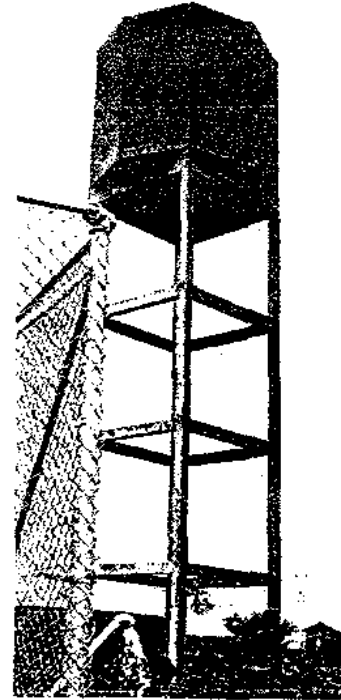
Estanque elevado de concreto armado de forma exagonal. Taguaya, Estado Monagas. Venezuela.
